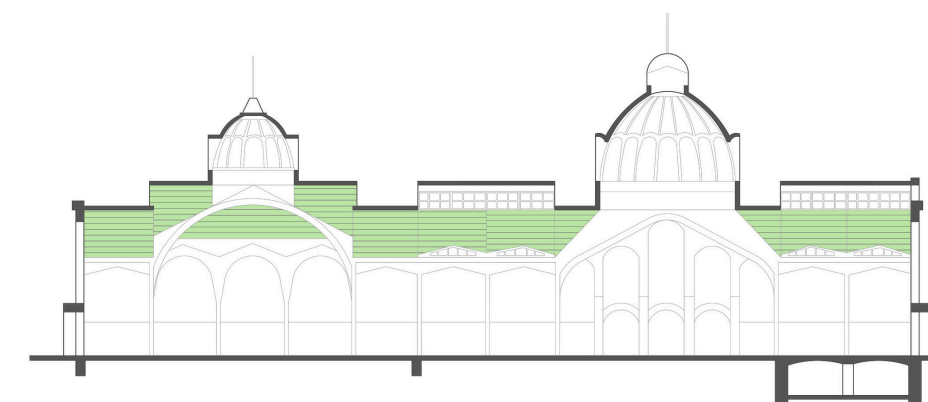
Abajo, esquema sobre los planos de cubierta del Mercado Central
